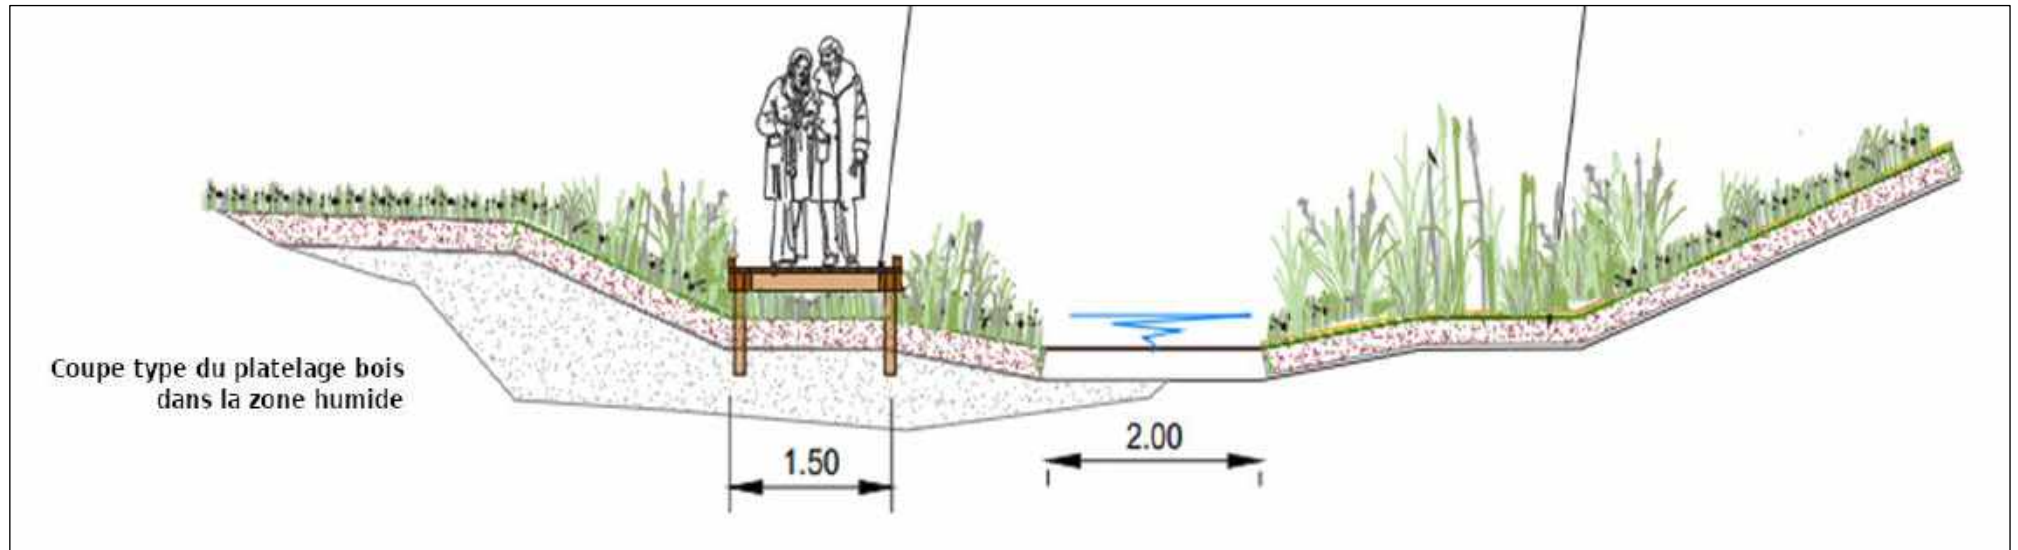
Profil en travers type d'une section restaurée du TH1 (SETEC/HYDRATEC)
